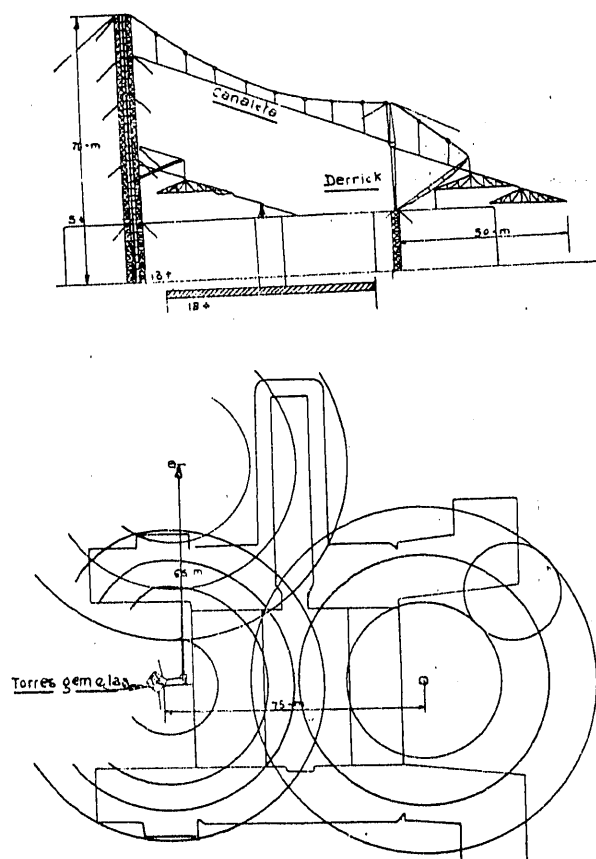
^a Esquema de la instalación de vertido del hormigón en la cabeza Este.
